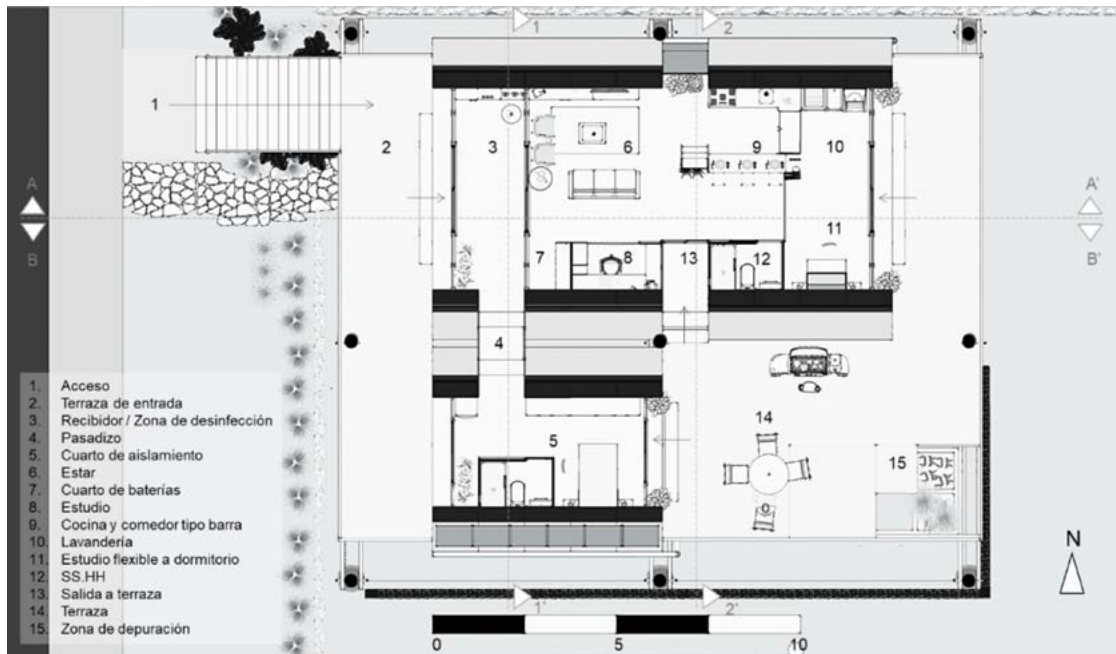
Planta arquitectónica principal // Fuente: Elaboración propia.
